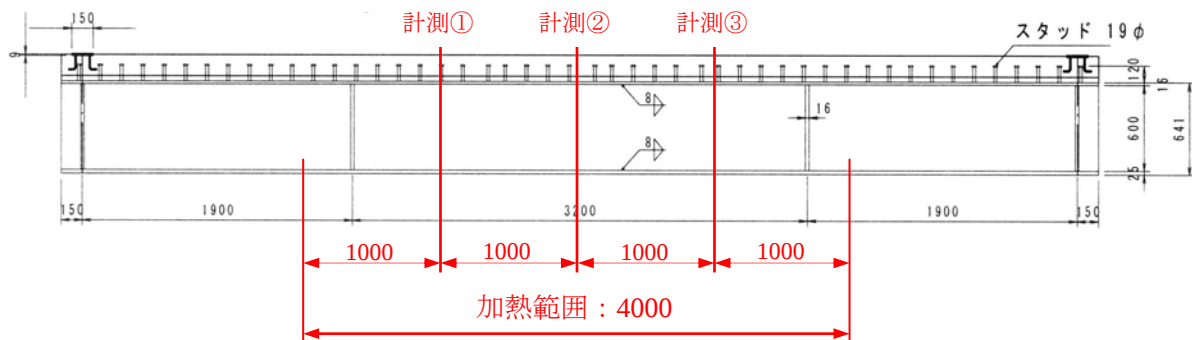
実験供試体の側面および熱電対設置位置 (単位: mm)
